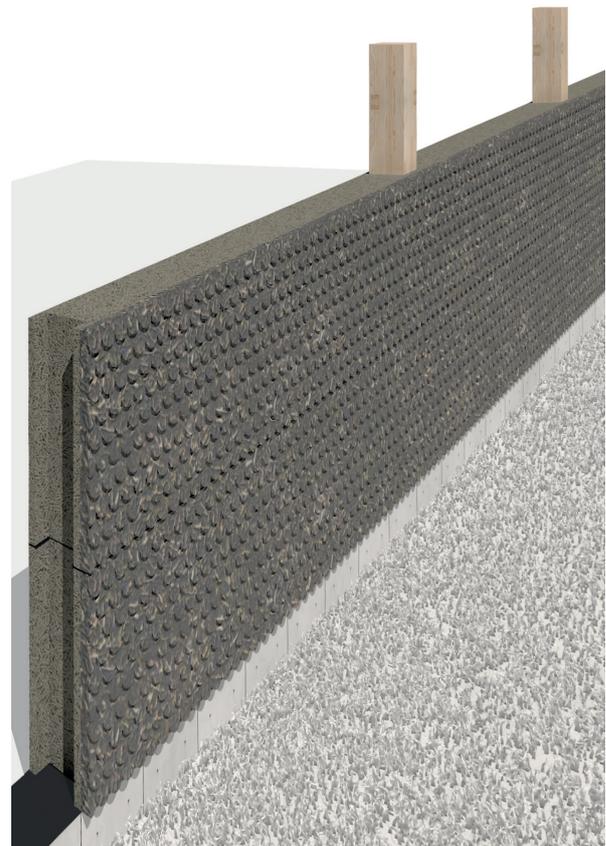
Holzleichtbeton Wandelemente eingeschoben zwischen Holzstützen
